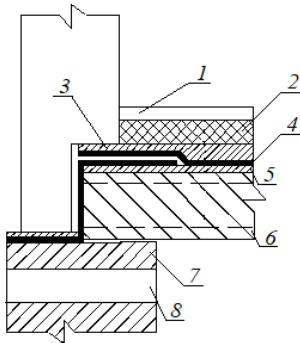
Сочетание сборного железобетонного перекрытия с мембраной: 1 — чистый пол; 2 — теплоизоляция; 3 — защитный слой; 4 — рулонный гидроизоляционный материал; 5 — выравнивающая стяжка; 6 — плита перекрытия; 7 — подполье; 8 — вентиляционный проход в цоколе
